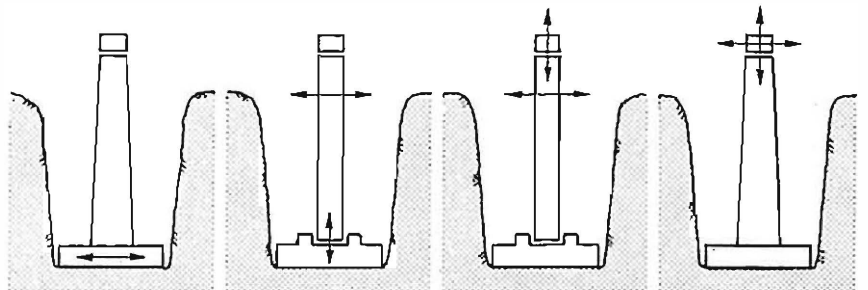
Mulige justeringsmåter ved prefabrierte pilarfundamenter.
